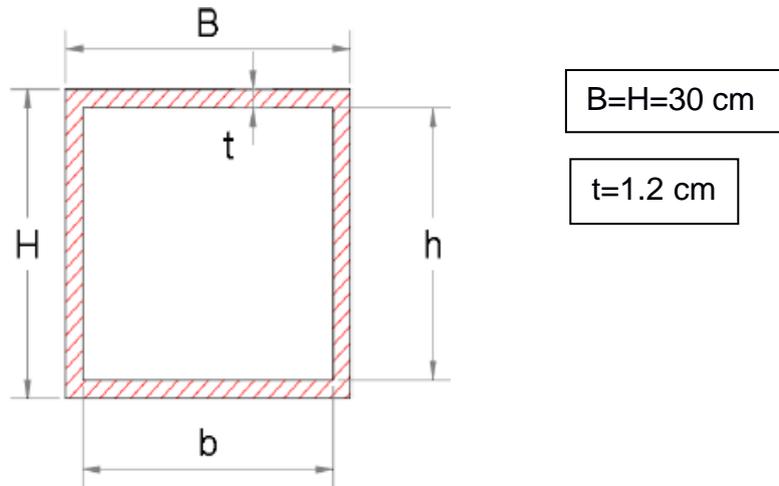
Dimensiones de columnas planta baja. Fuente: Los autores.
